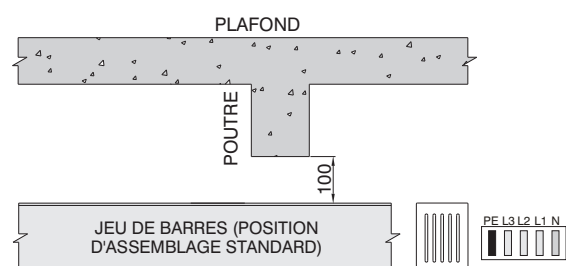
CROISEMENT D'UNE POUTRE EN POSITION HORIZONTALE
